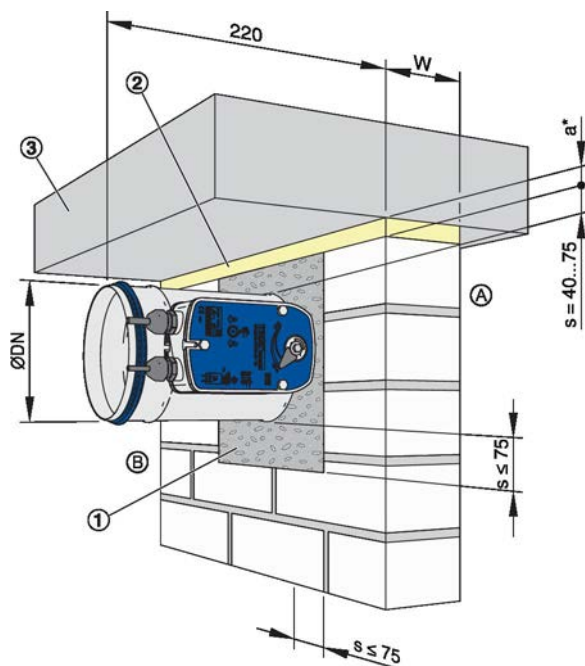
Montage à base de mortier dans un mur plein avec un joint de plafond souple
